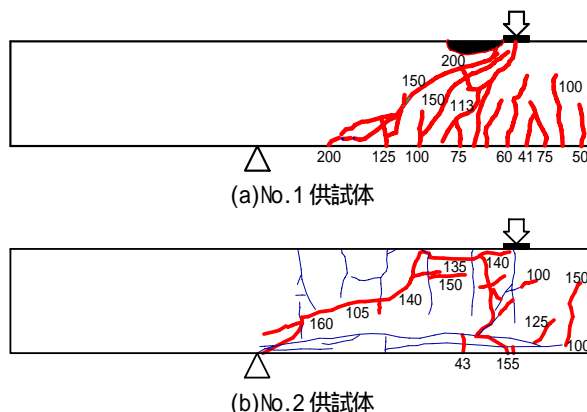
ひび割れ図 (細線：電食後、太線：載荷後)
